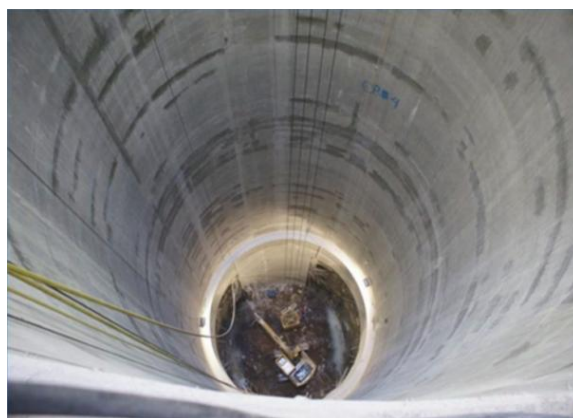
3 Construcción de lumbrera (Muro Milán)
